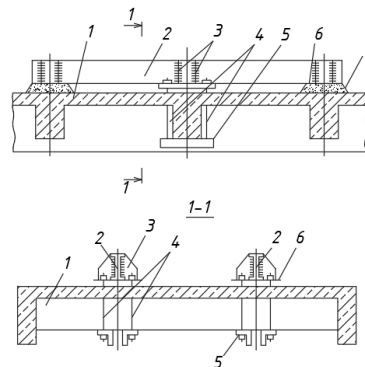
Підсилення балки і плити перекриття металевими балками зверху: 1 - зруйнована балка; 2 - металева балка; 3 - ребра жорсткості; 4 - тяжі; 5 - планка; 6 - опорні листи; 7 - опорні подушки
